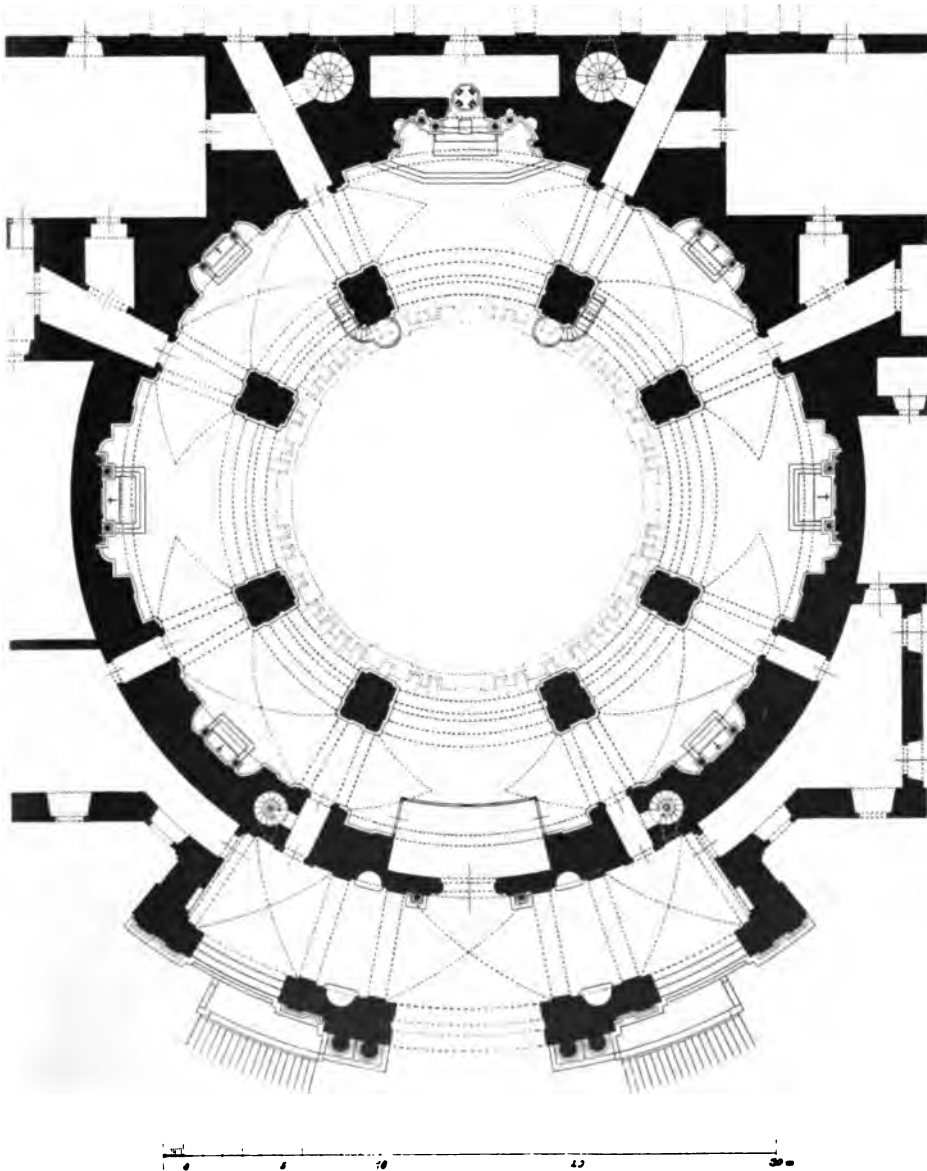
Kirche des Jesuitenkollegs in Loyola Grundriß (Aufnahme des Verfassers)
